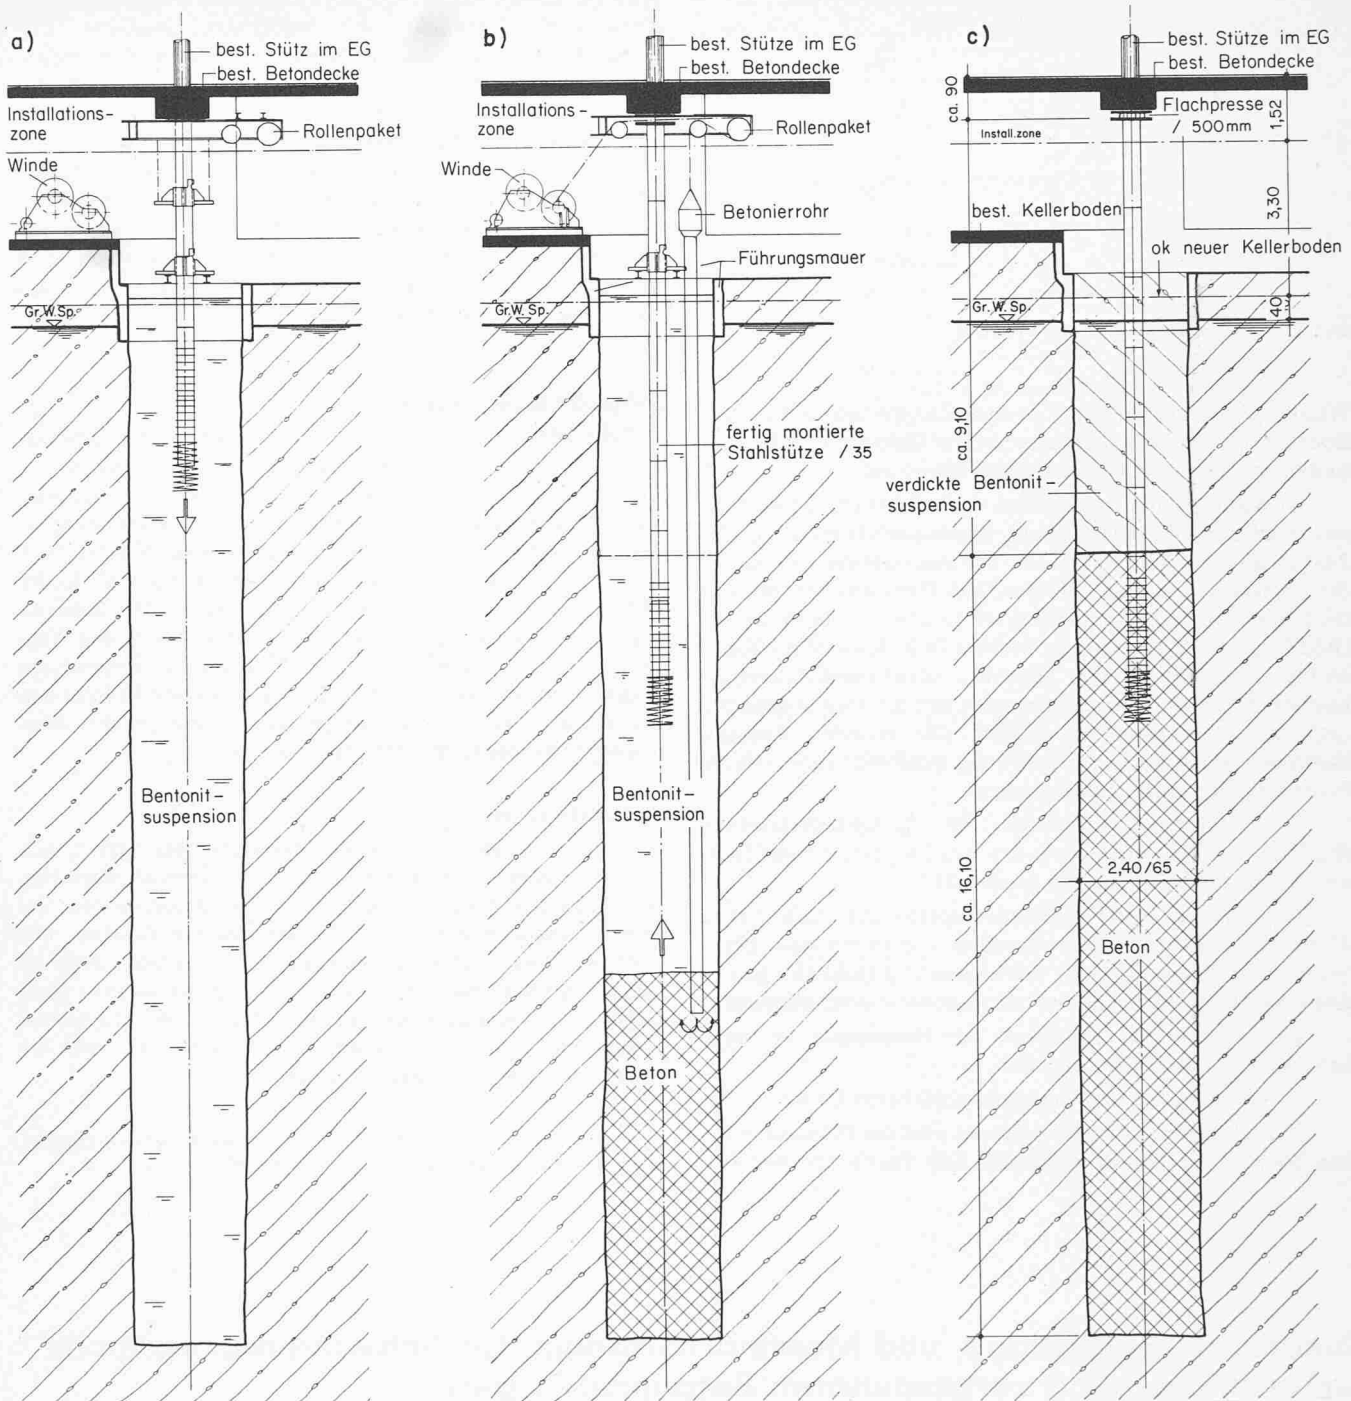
Einbau der Stützen. a) Stützenabsenkung b) Betonieren des Pfahles c) Fertiger Pfahl
